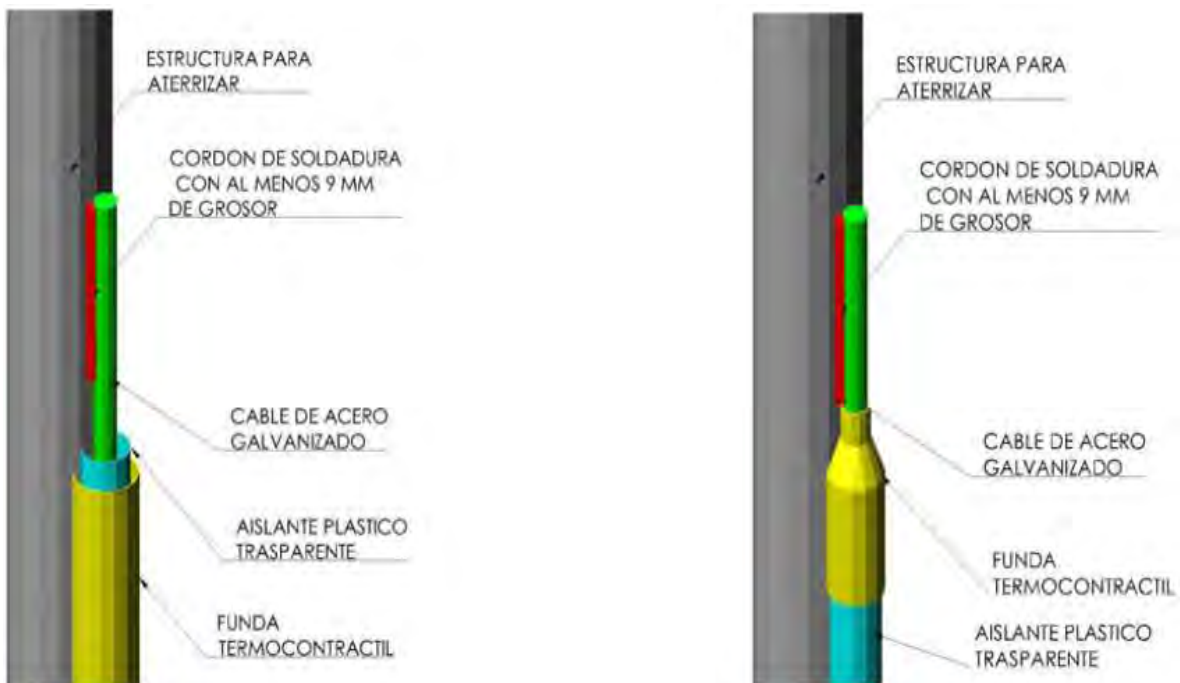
Soldado del cable de acero galvanizado y la estructura.
